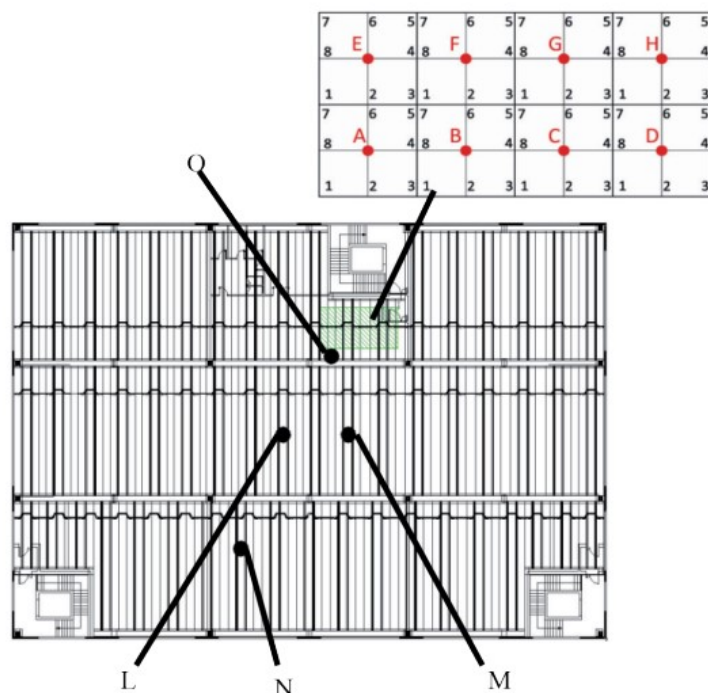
Rappresentazione in pianta del posizionamento dei campioni prelevati per lo svolgimento delle prove ad ultrasuoni (Flavio Stochino, Fausto Mistretta, Paola Meloni, Gianfranco Carcangiu (2017), *Integrated Approach for Post-fire Reinforced Concrete Structures Assessment*).
